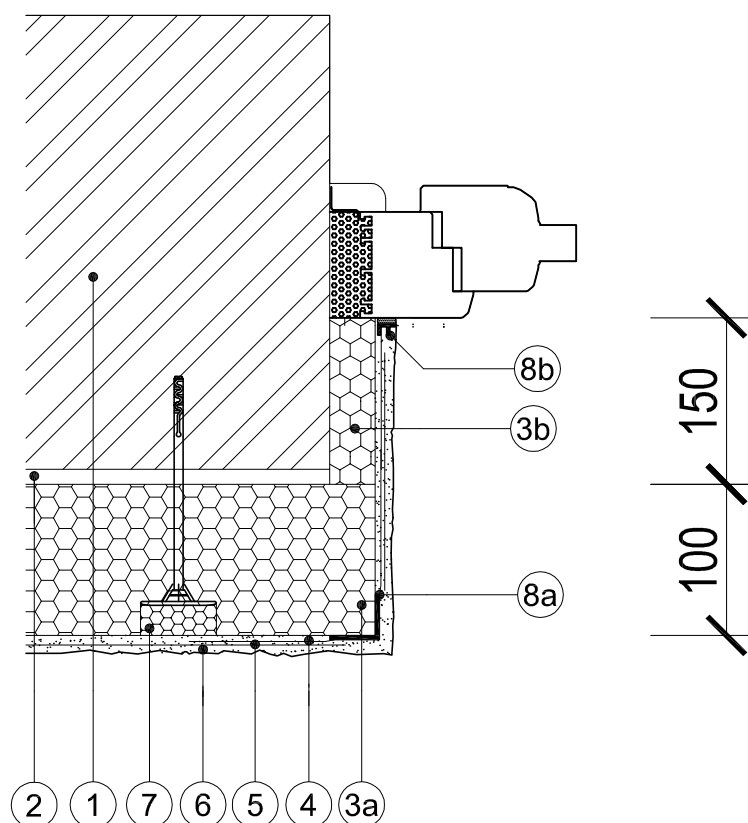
# DETAIL D (VZOROVÝ DETAIL- NAPOJENÍ ZATEPLENÍ NA OPLECHOVÁNÍ PARAPETU )
